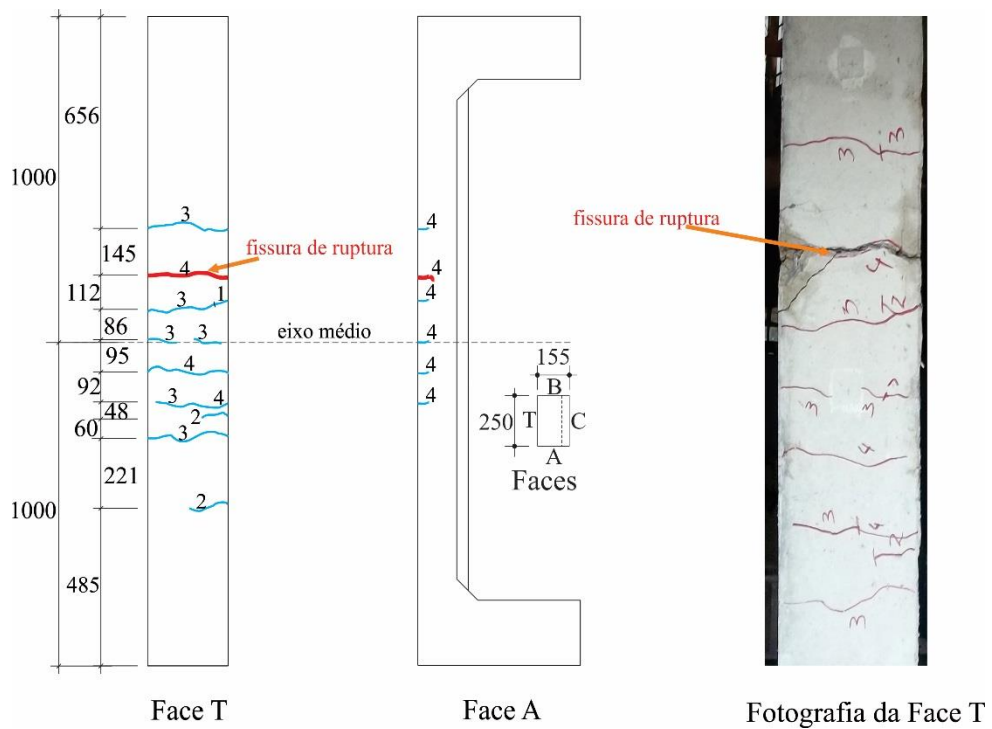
56 - Fissuras nas Faces T e A; Fotografia da face T - pilar PPBA-150-34
